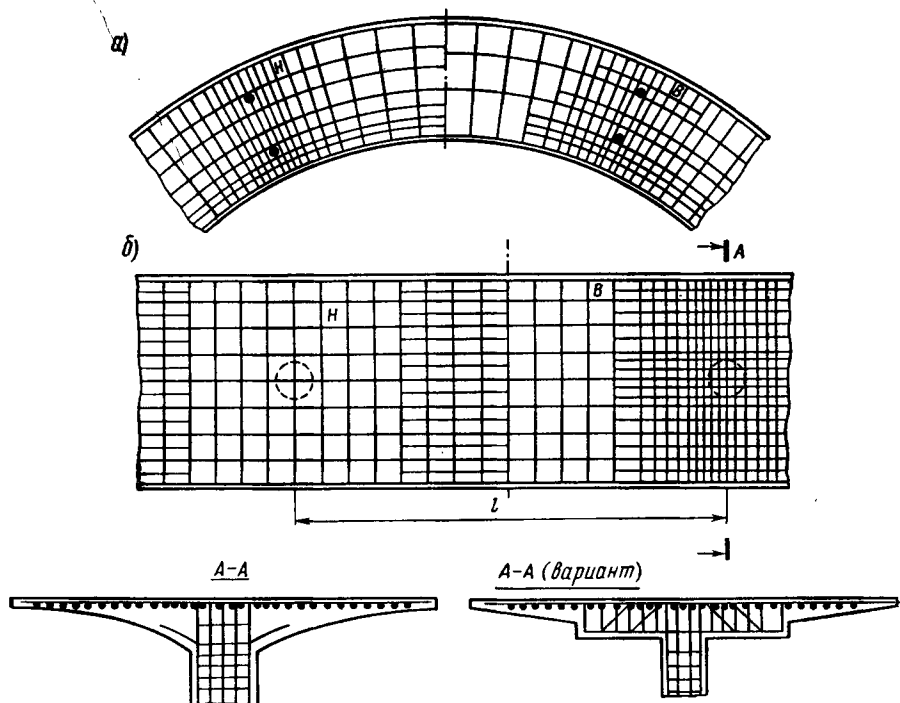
Схемы армирования ненапрягаемой арматурой криволинейных плитных пролетных строений с точечным опиранием и на столбчатых опорах:
